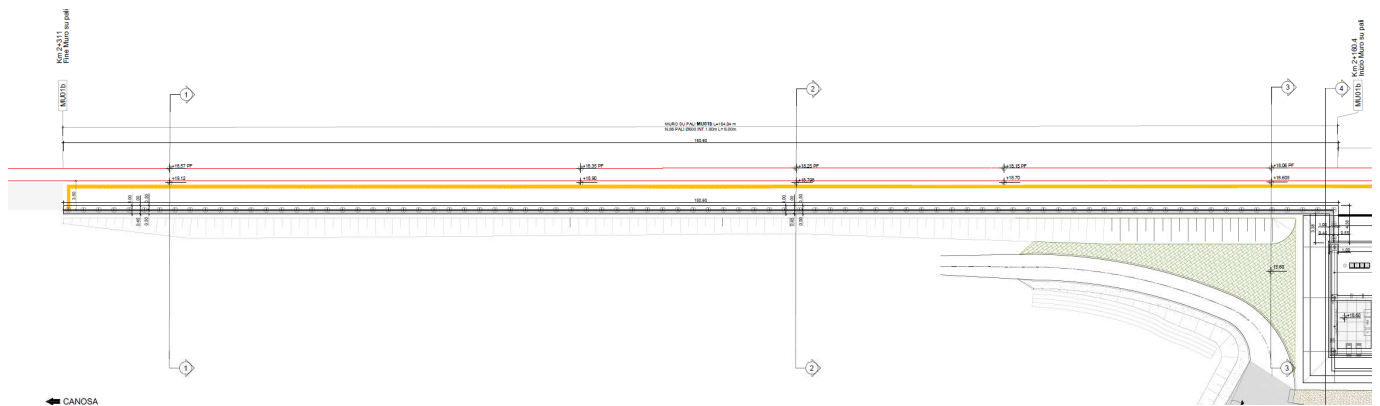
Muro di sostegno su pali – Pianta lato ovest del fabbricato.
